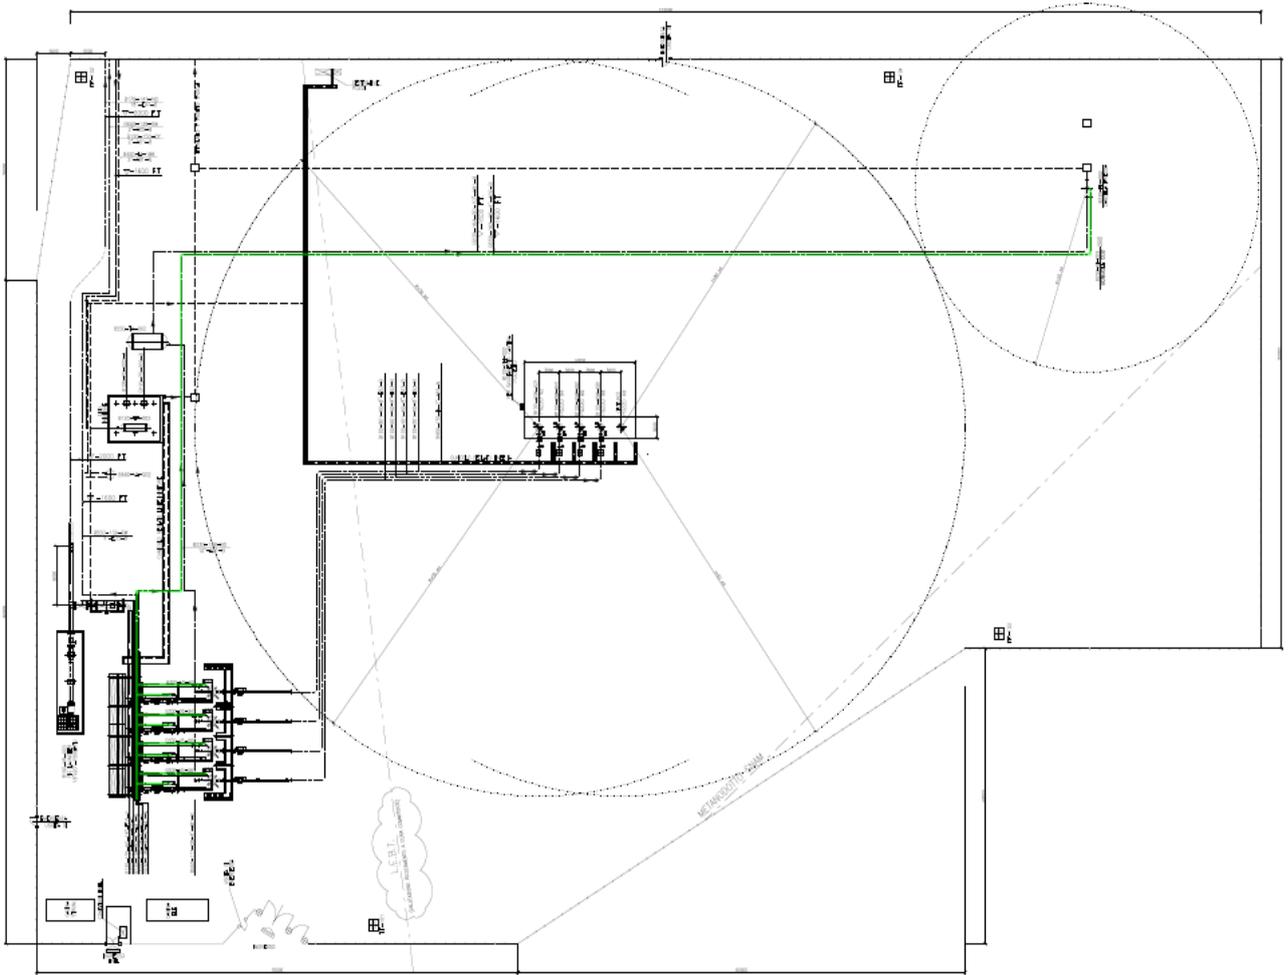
Planimetria andamento tubazioni- Collettore per BDV e PSV
